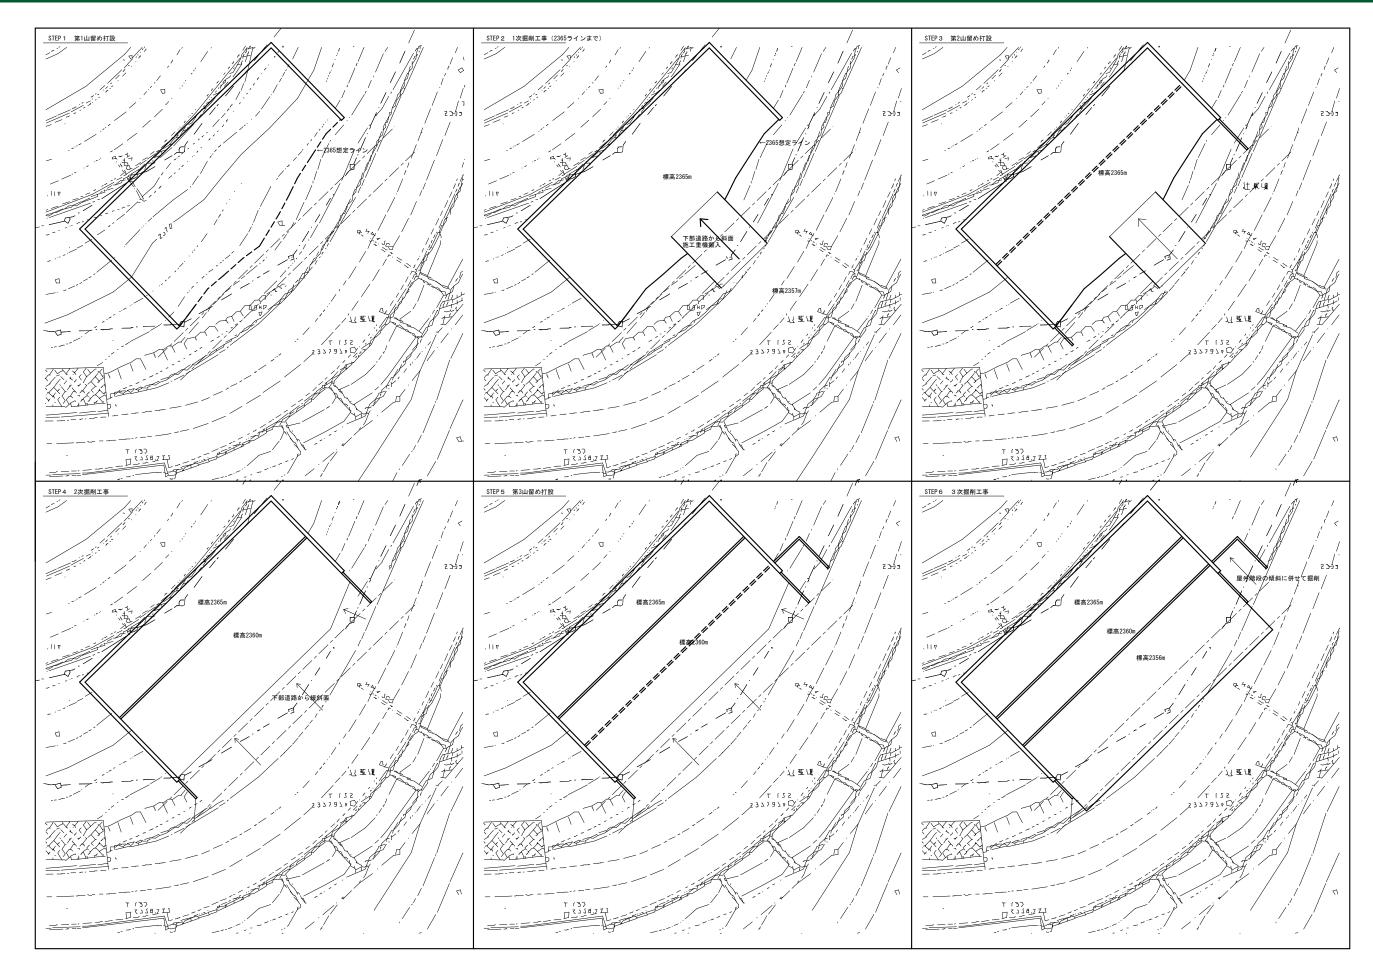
山留・造成計画案 ステップ図 (平面)
